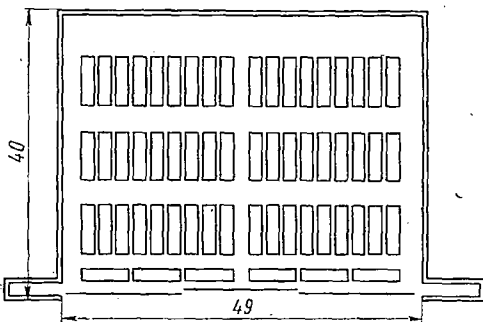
План ангара с размещением змеевиков водяного напольного отопления
